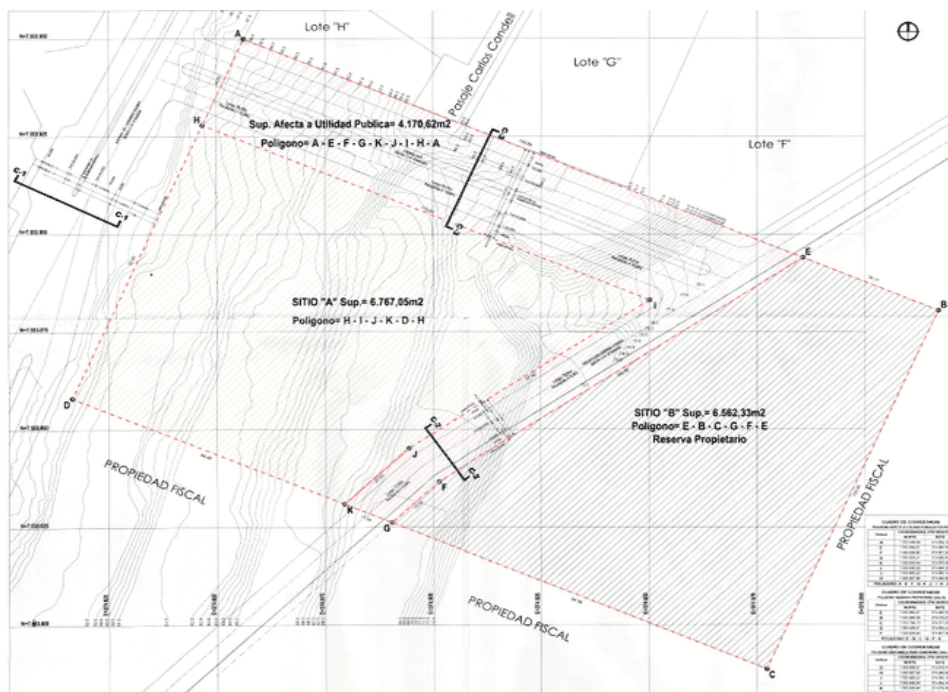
Ubicación Proyecto Terrazas de Bellavista, sitio A, Tocopilla.
